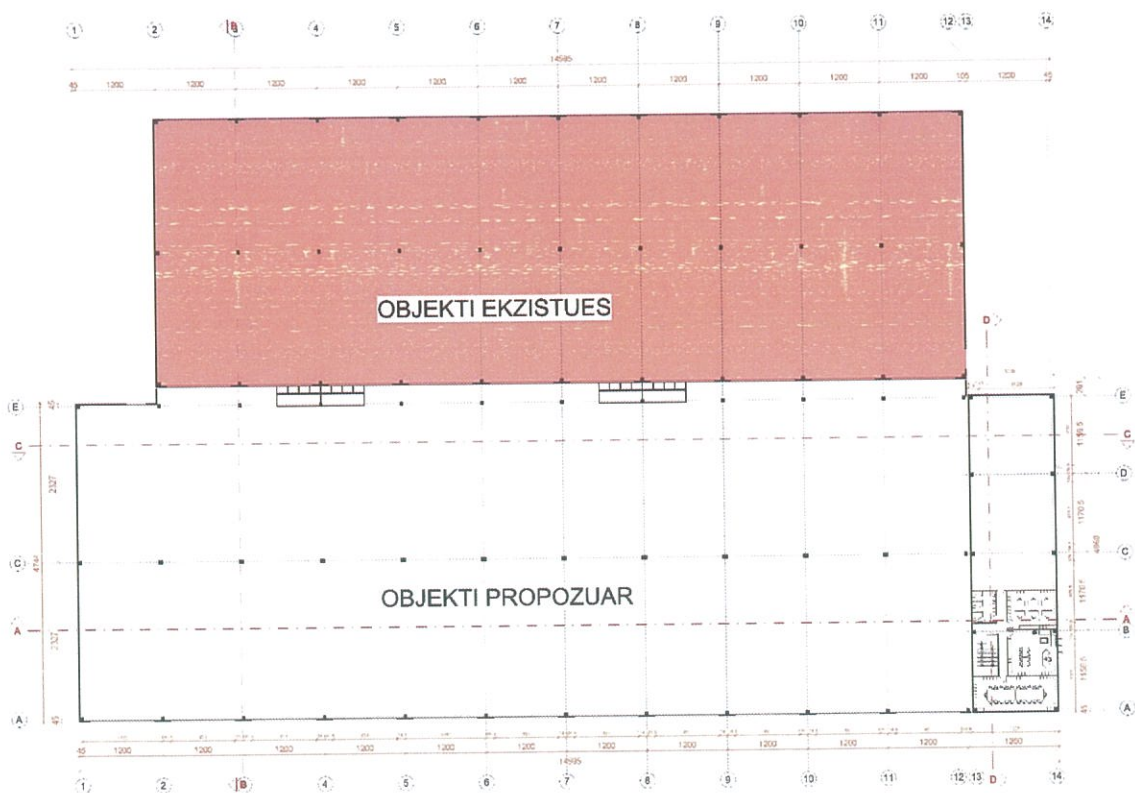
Planimetria e katit të parë, kuota  $+ 4.15$
